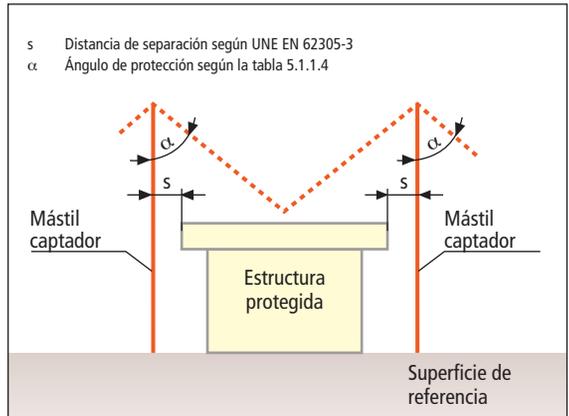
Sistema de protección externa contra rayos aislado con dos mástiles captadores separados de acuerdo con el procedimiento de ángulo de protección: Proyección sobre una superficie vertical.
